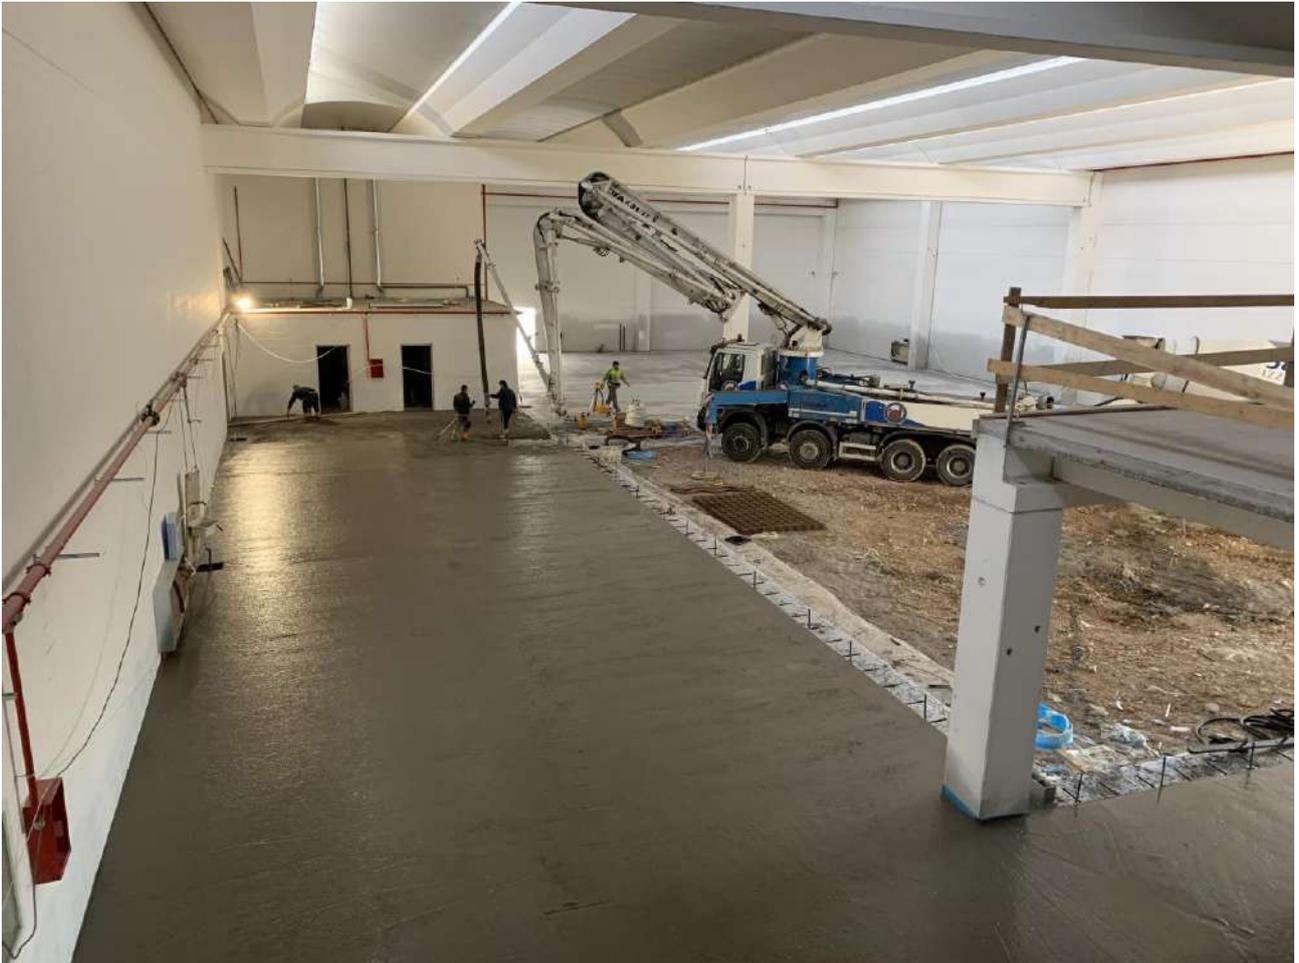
Fasi di getto della pavimentazione fibrinforzata con FIBRAG® POLY: PSF 55-TP – AREA 2-PACK LINE
